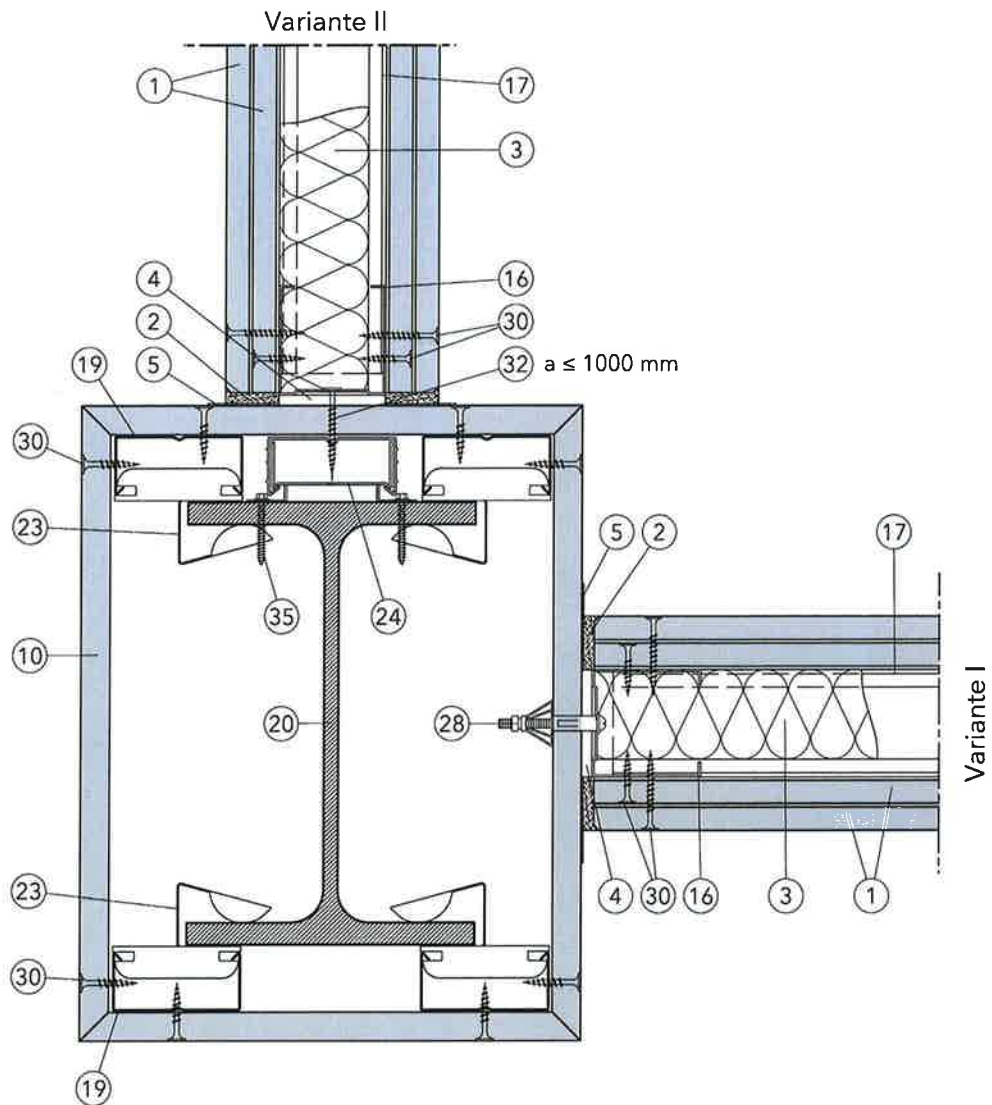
Horizontalschnitt Anschluss an Stahlstützen mit Unterkonstruktion
